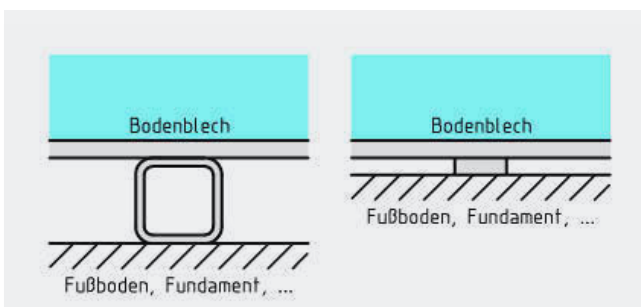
Bodenformen bei Metallbehältern. Foto: Autor
